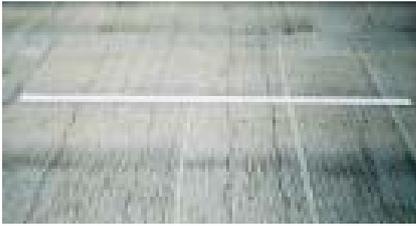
Fisuras por contracción, tales como las enseñadas en este tablero de puente, se pueden reducir con prácticas adecuadas de colocación, acabado y curado de concreto y con el uso de aditivos reductores de contracción.
